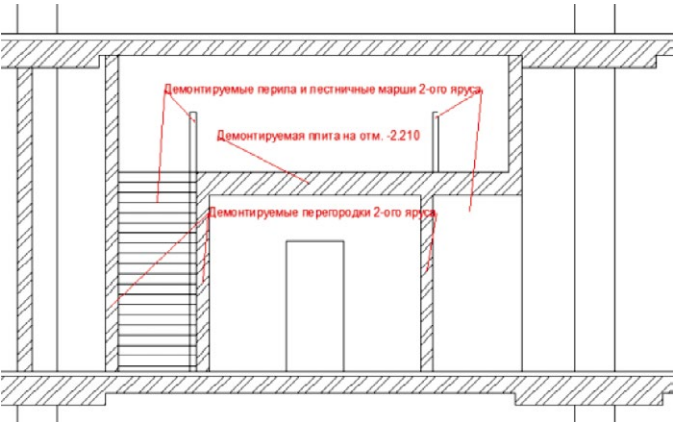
Демонтируемые конструкции 2 стадии: ограждение и лестницы 2 уровня, плита на отм. -2.210, перегородки из газобетона 1-го и 2-го яруса
